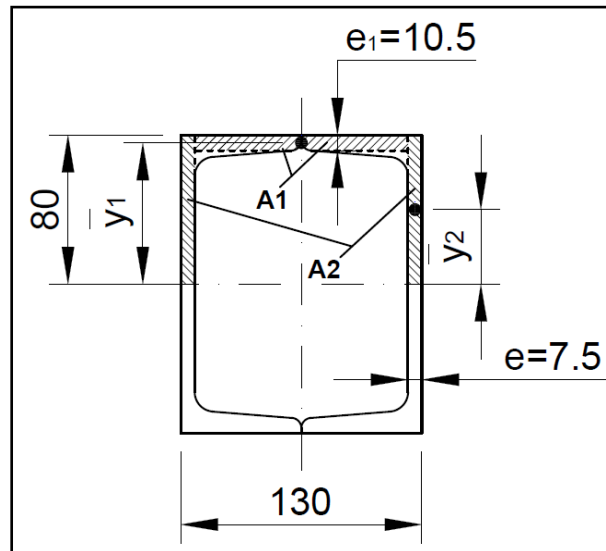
Dimensiones de la sección de las vigas transversales.
